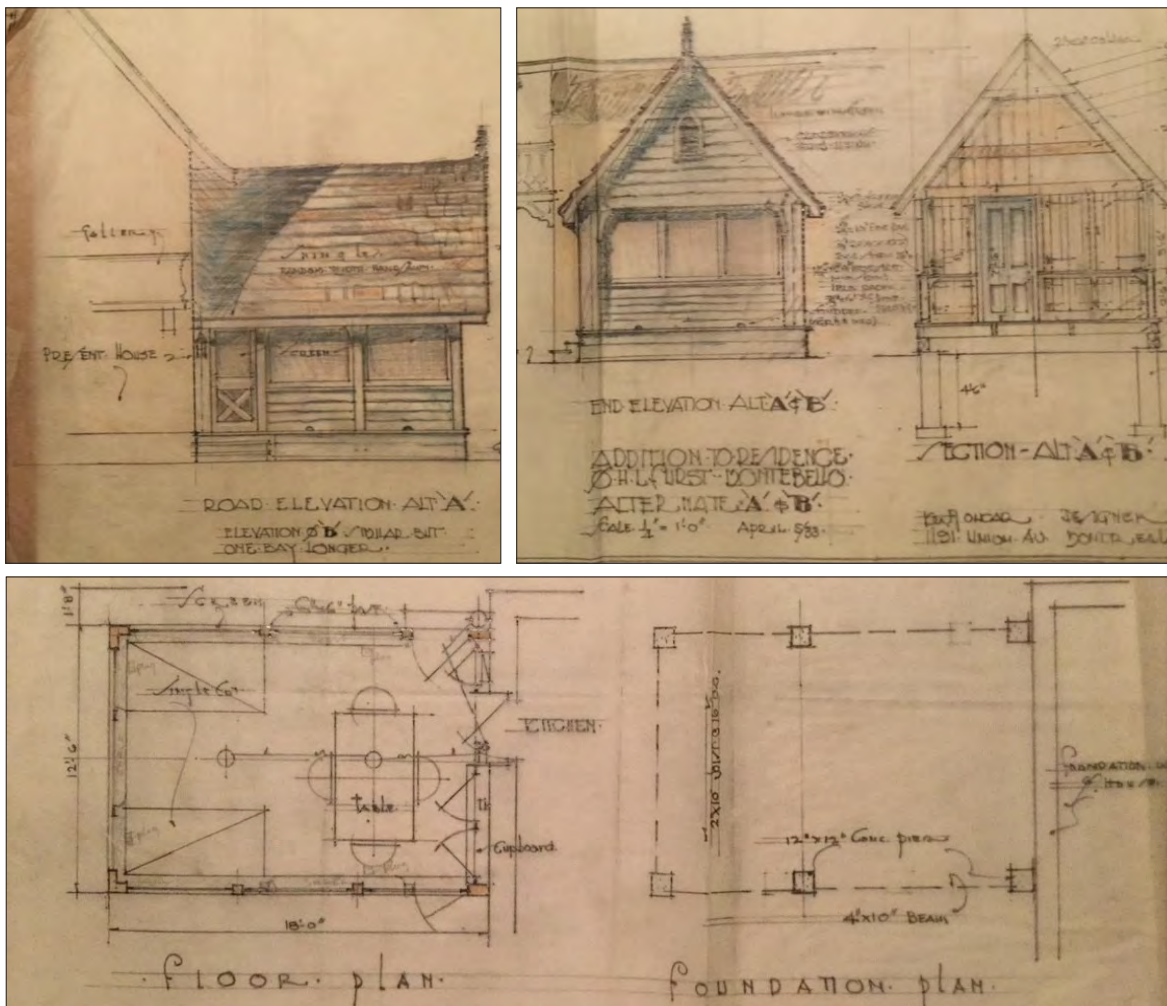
Plans de construction de l'annexe, 1932. Source : Archives Fairmont Château Montebello.
